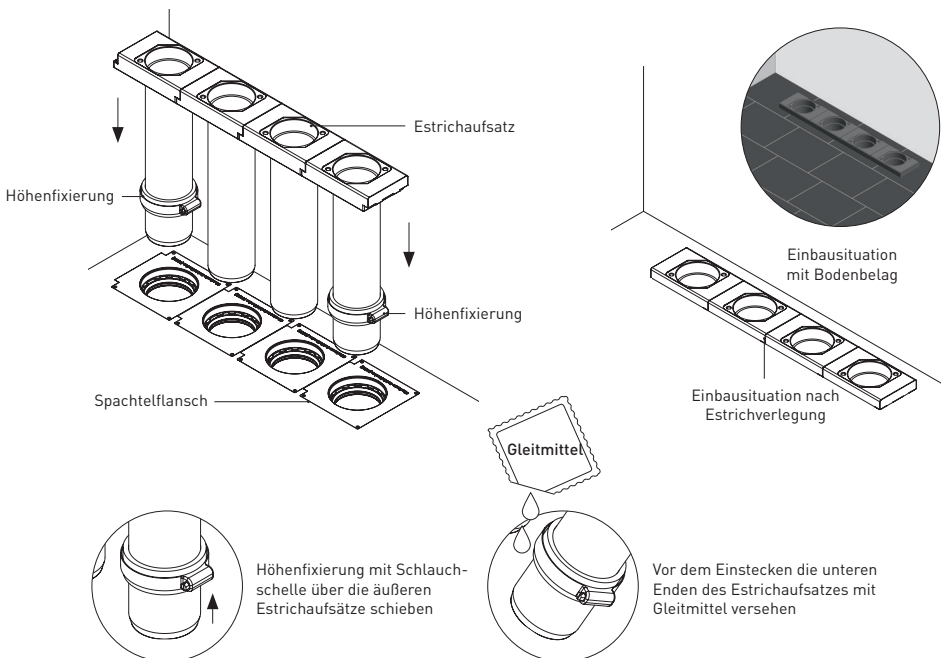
Einstecken des Estrichaufsatzes mit Höhenfixierung, Einbausituation
